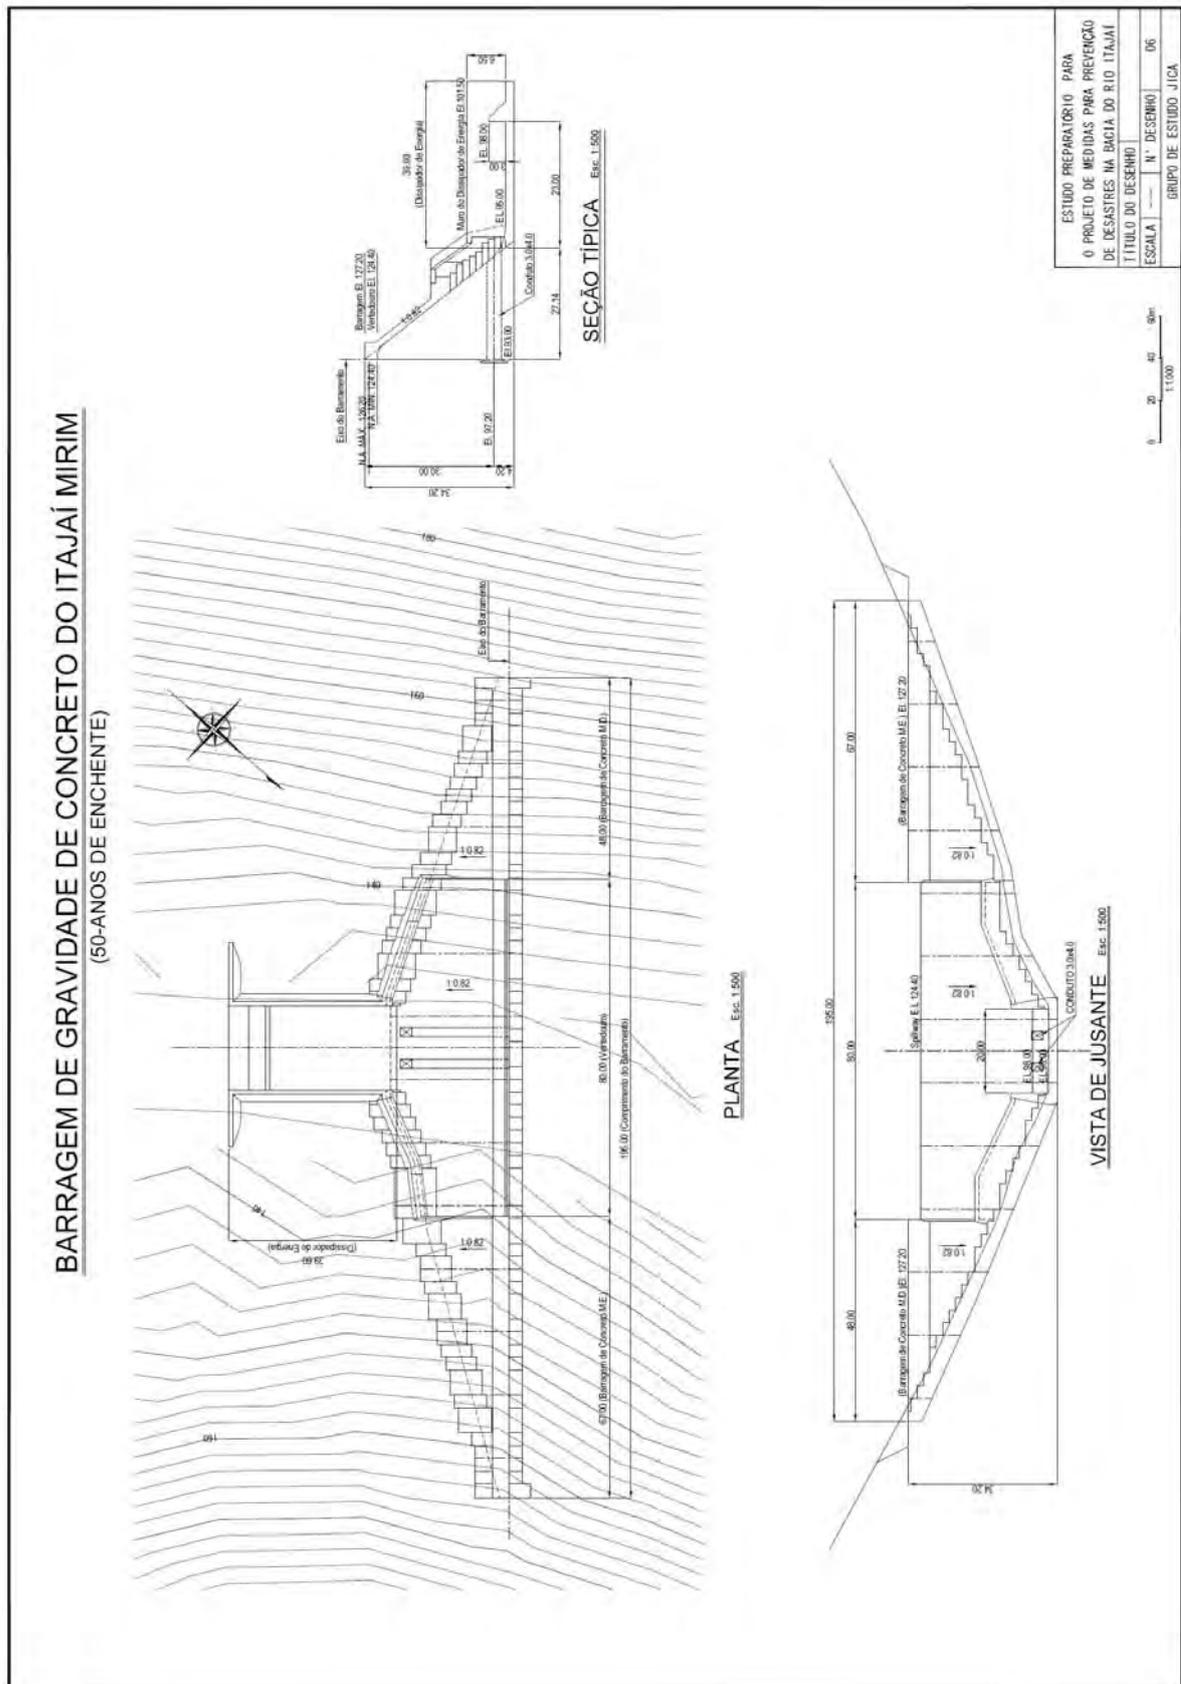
Projeto estrutural da barragem de concreto-gravidade de Itajaí Mirim
